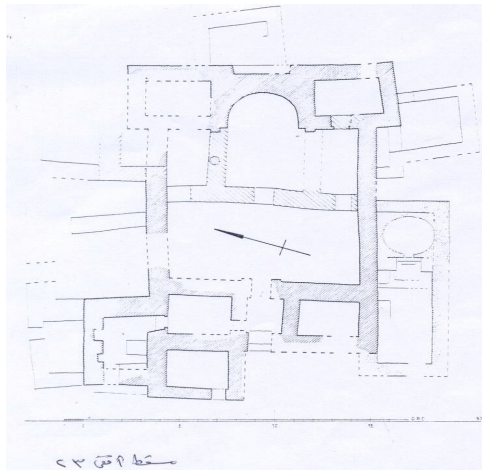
مسقط أفقي للكنيسة الغربية بأوستراسيني. نقلاً عن.
